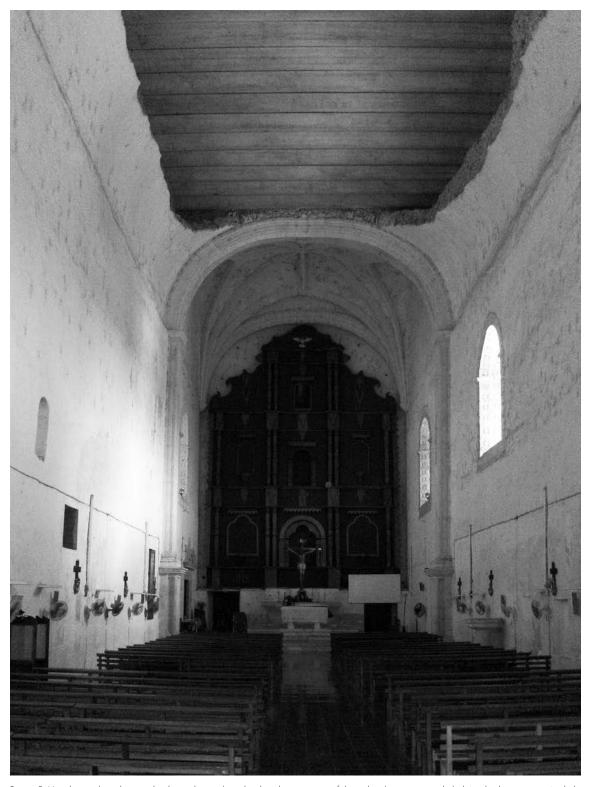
Vista hacia el presbiterio, donde se observa la techumbre de concreto prefabricado y los arranques de la bóveda de mampostería de la nave de la iglesia conventual de Santa Clara, Dzidzantún, Yucatán. Fotografía de los autores.
